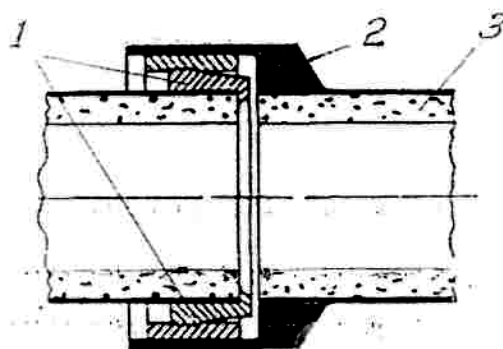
Конструкция стыкового соединения стальных труб вкладышей, облицованный шлаковым литьем:
